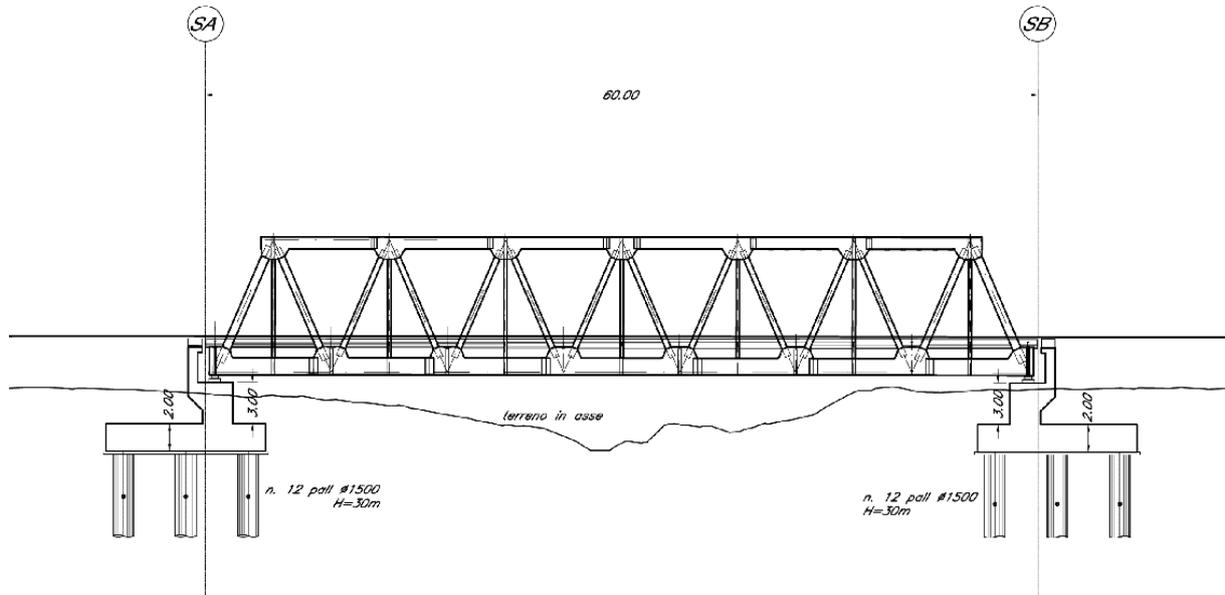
VI22 – Prospetto dell'opera su profilo del terreno
